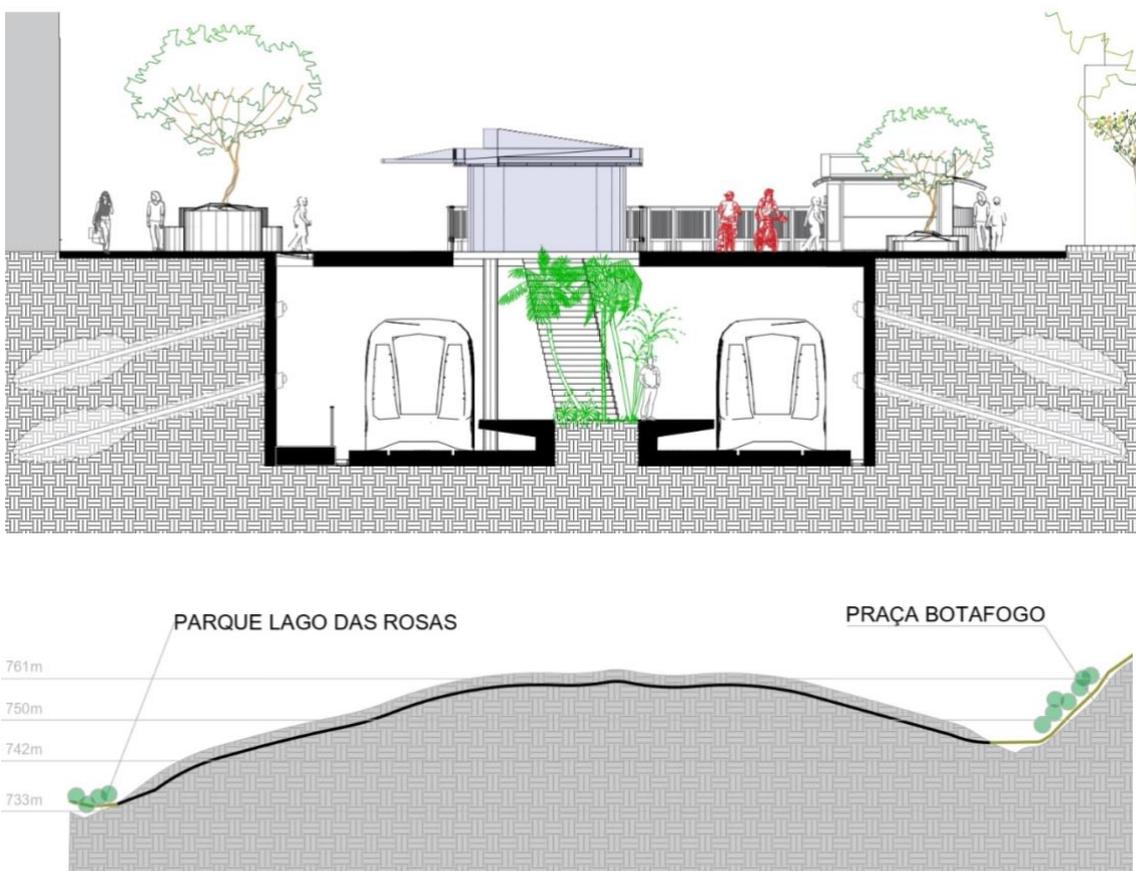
Corte transversal (acima) e longitudinal (abaixo) da Av. Anhanguera detalhando a implantação do túnel. Fonte: Arquivo pessoal
